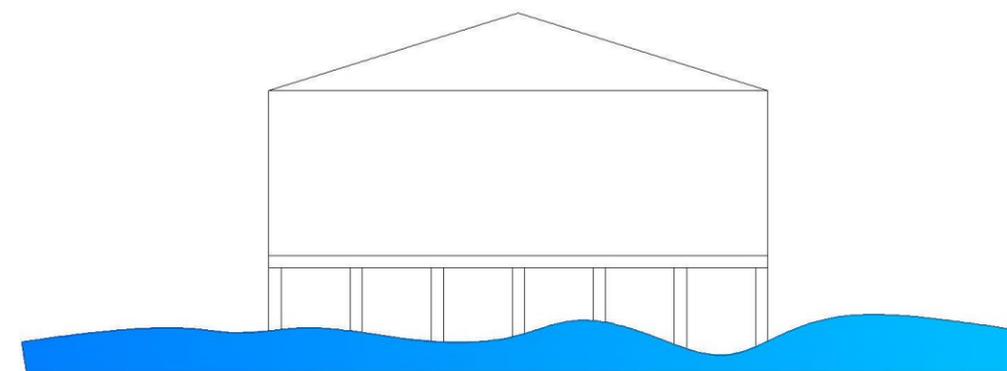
Empleo de pilotes en vivienda con riesgo de inundación. Fuente: equipo de trabajo
